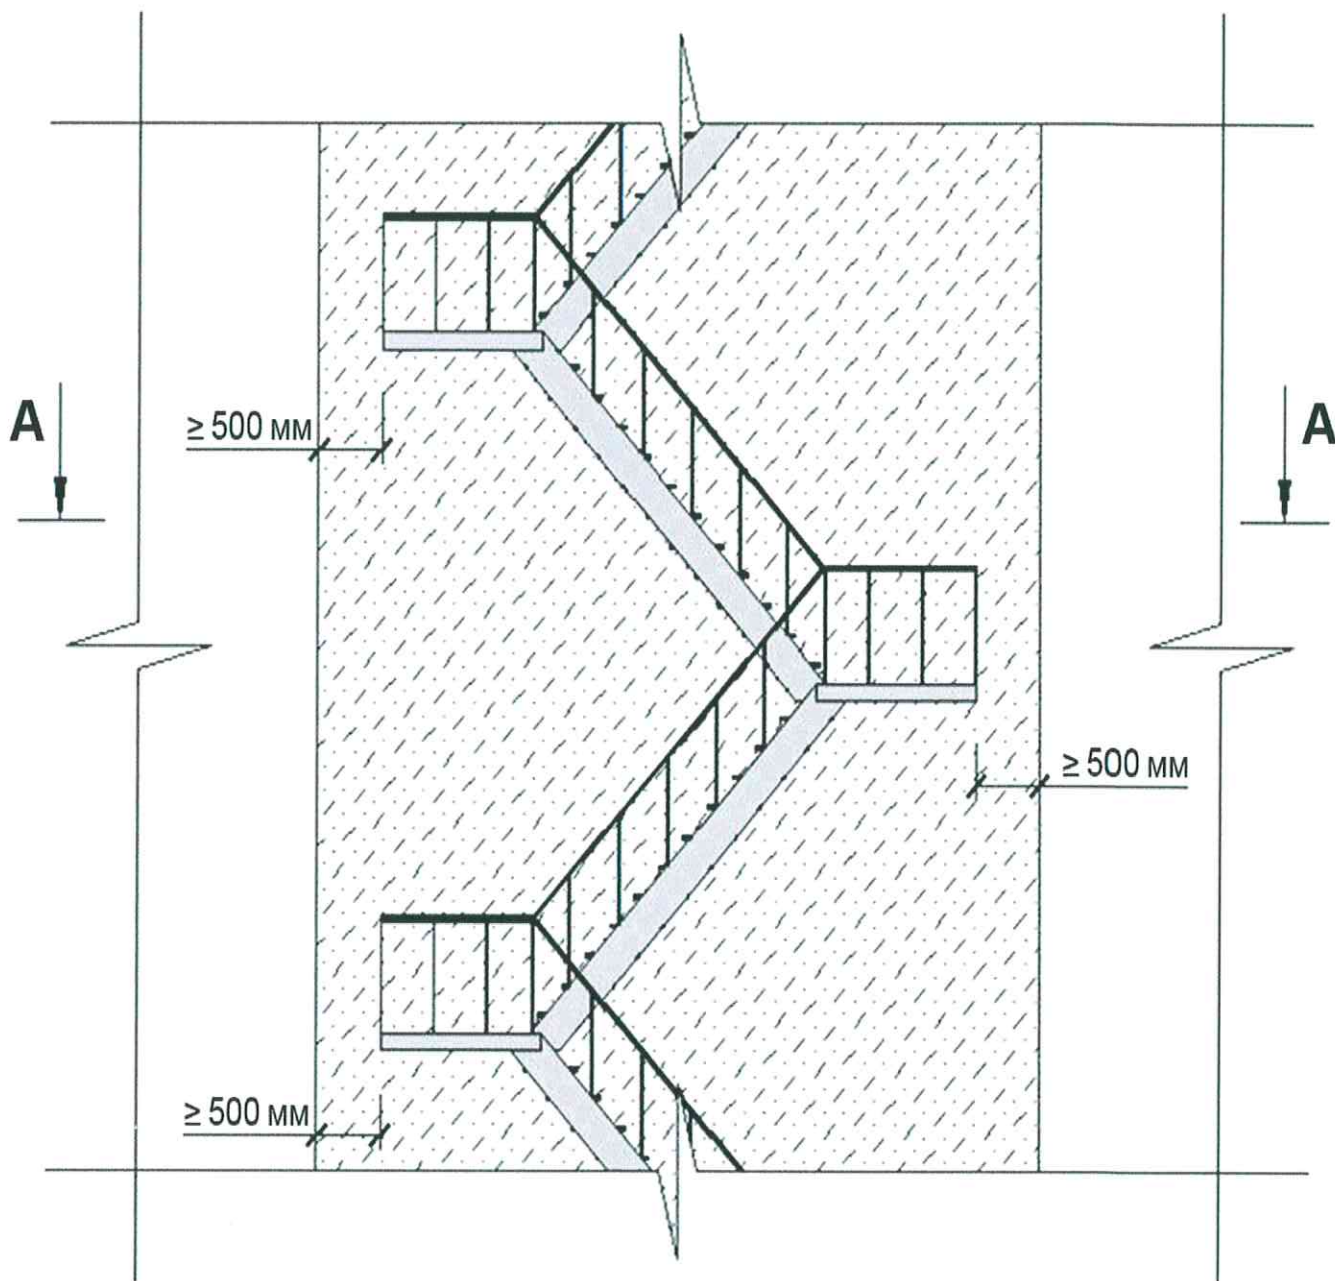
Участки примыкания СФТК к пожарной или наружной маршевой лестнице здания
